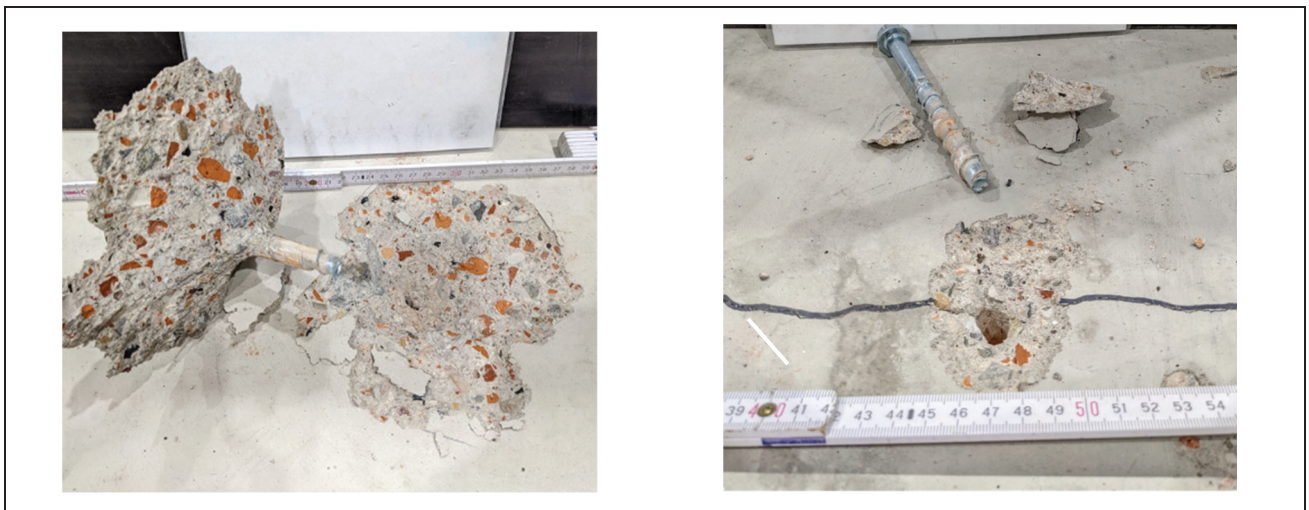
Versagensart kegelförmiger Betonausbruch und Herausziehen, Betonschraube H, links ungerissener, rechts gerissener Beton
